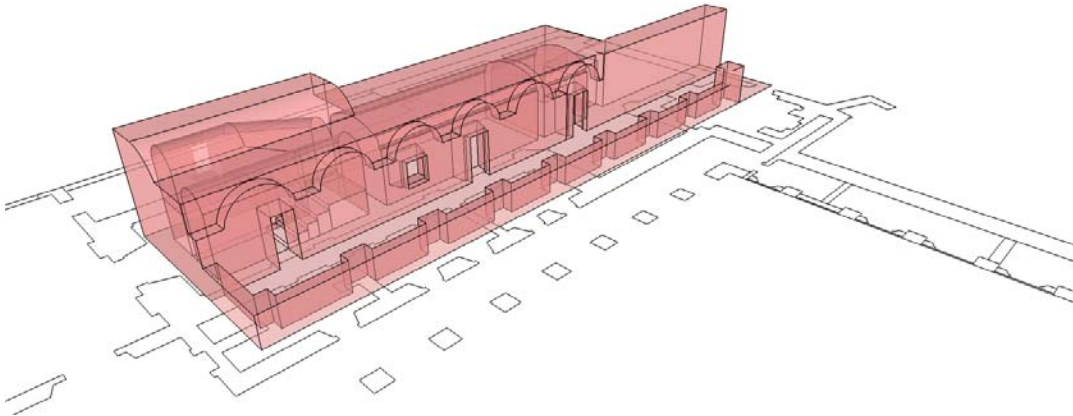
Reconstrucción Virtual Sector 1 b: Ala Sur Planta Alta.
